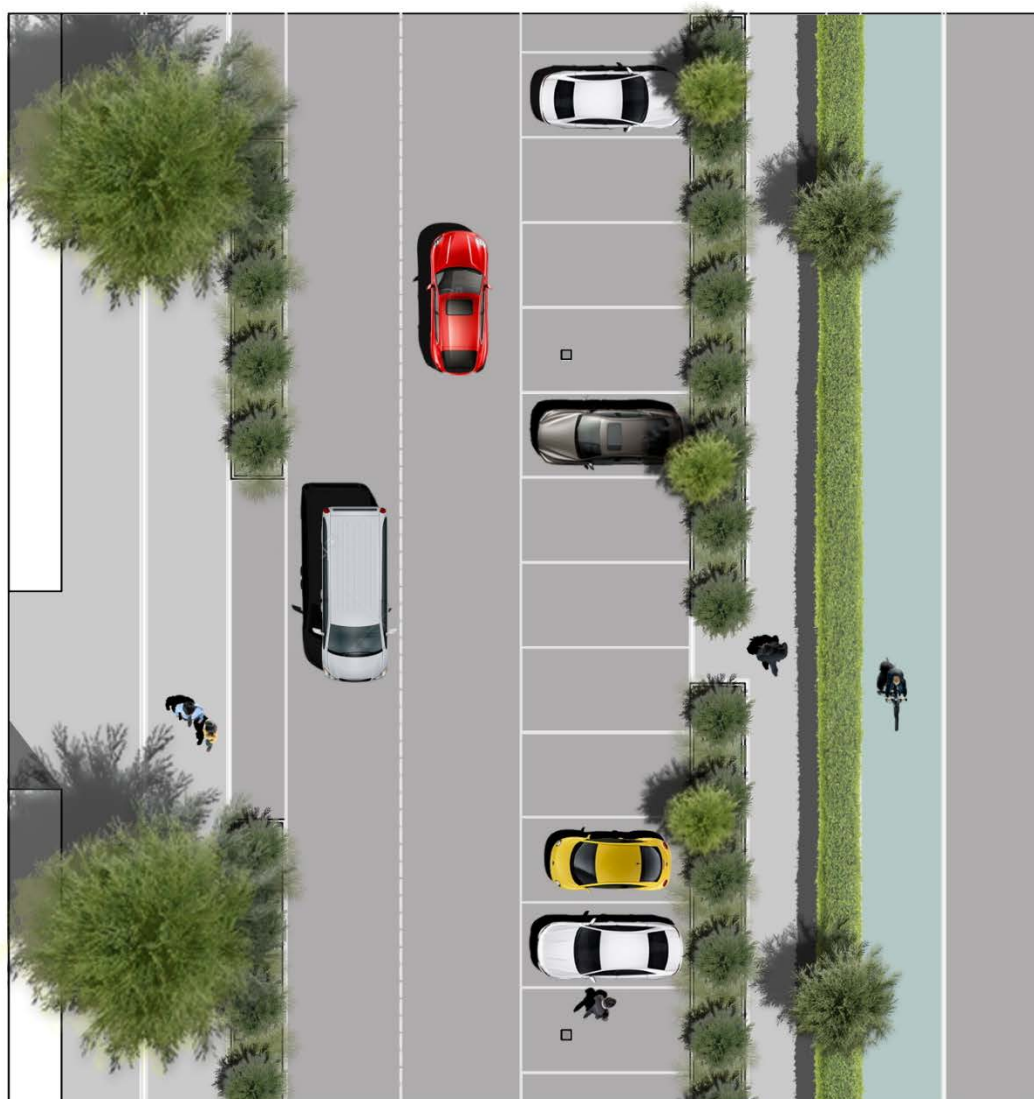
Stato di progetto – Alternativa 3.2. Planimetria e sezione di un tratto di Via Lombardia, Città di Parabiago (MI)
